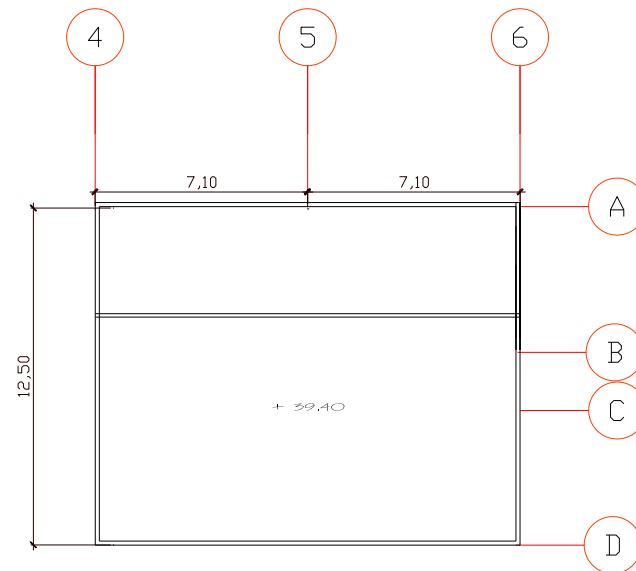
7 Denah Lantai 2-7 Gedung (Tipikal)
